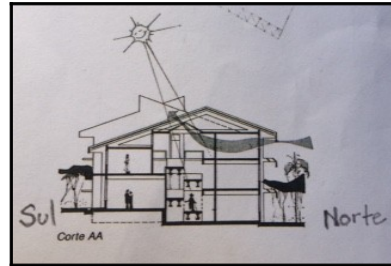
Corte esquemático – PROJETO, São Paulo, set. 1993.
